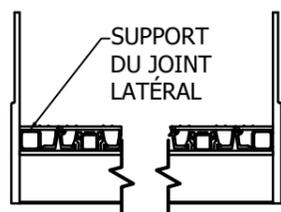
LATTE COUPÉE JOINT LATÉRAL
